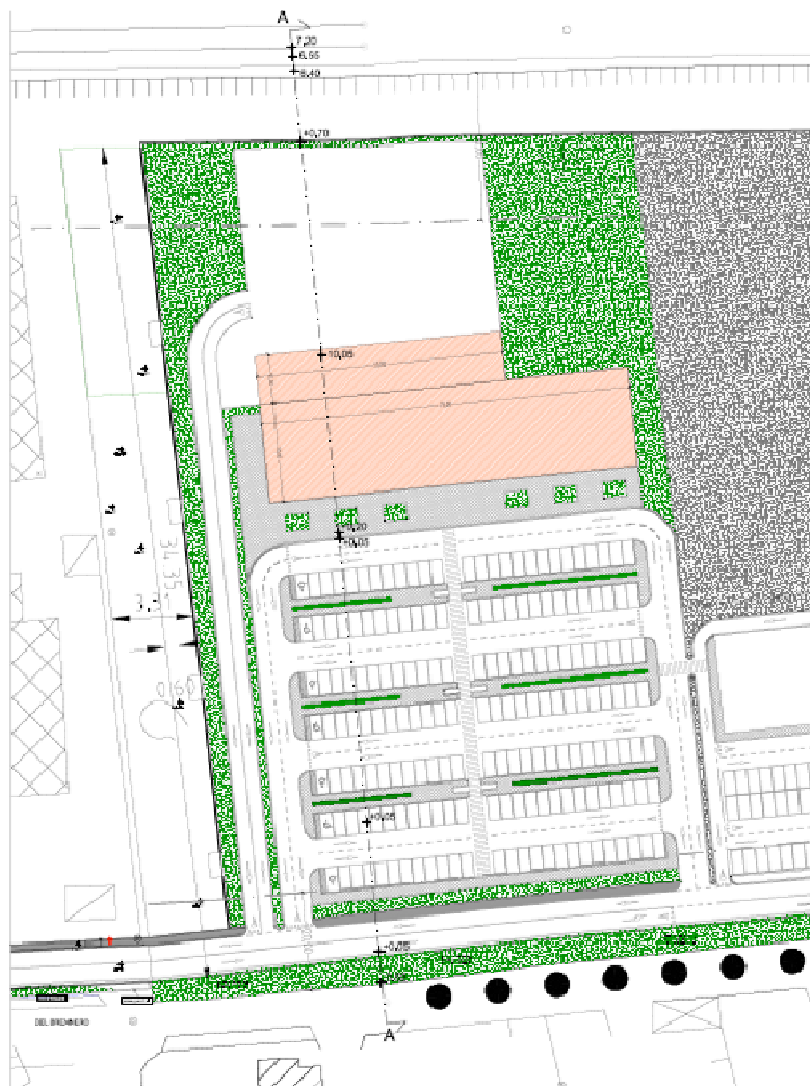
LOTTO 1: PLANIMETRIA DI PROGETTO
